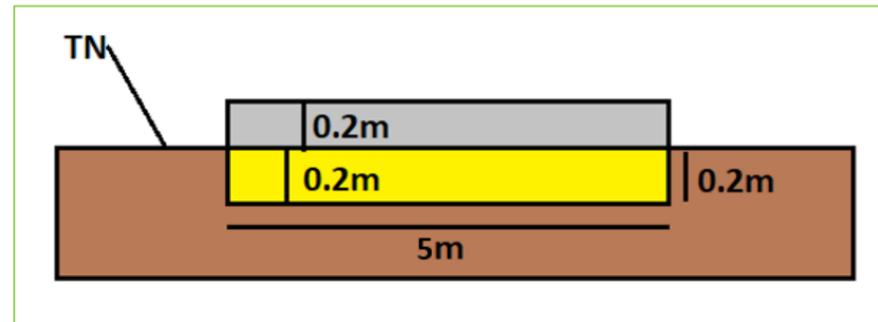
Coupe type d'une piste lourde (source : PHOTOSOL)
